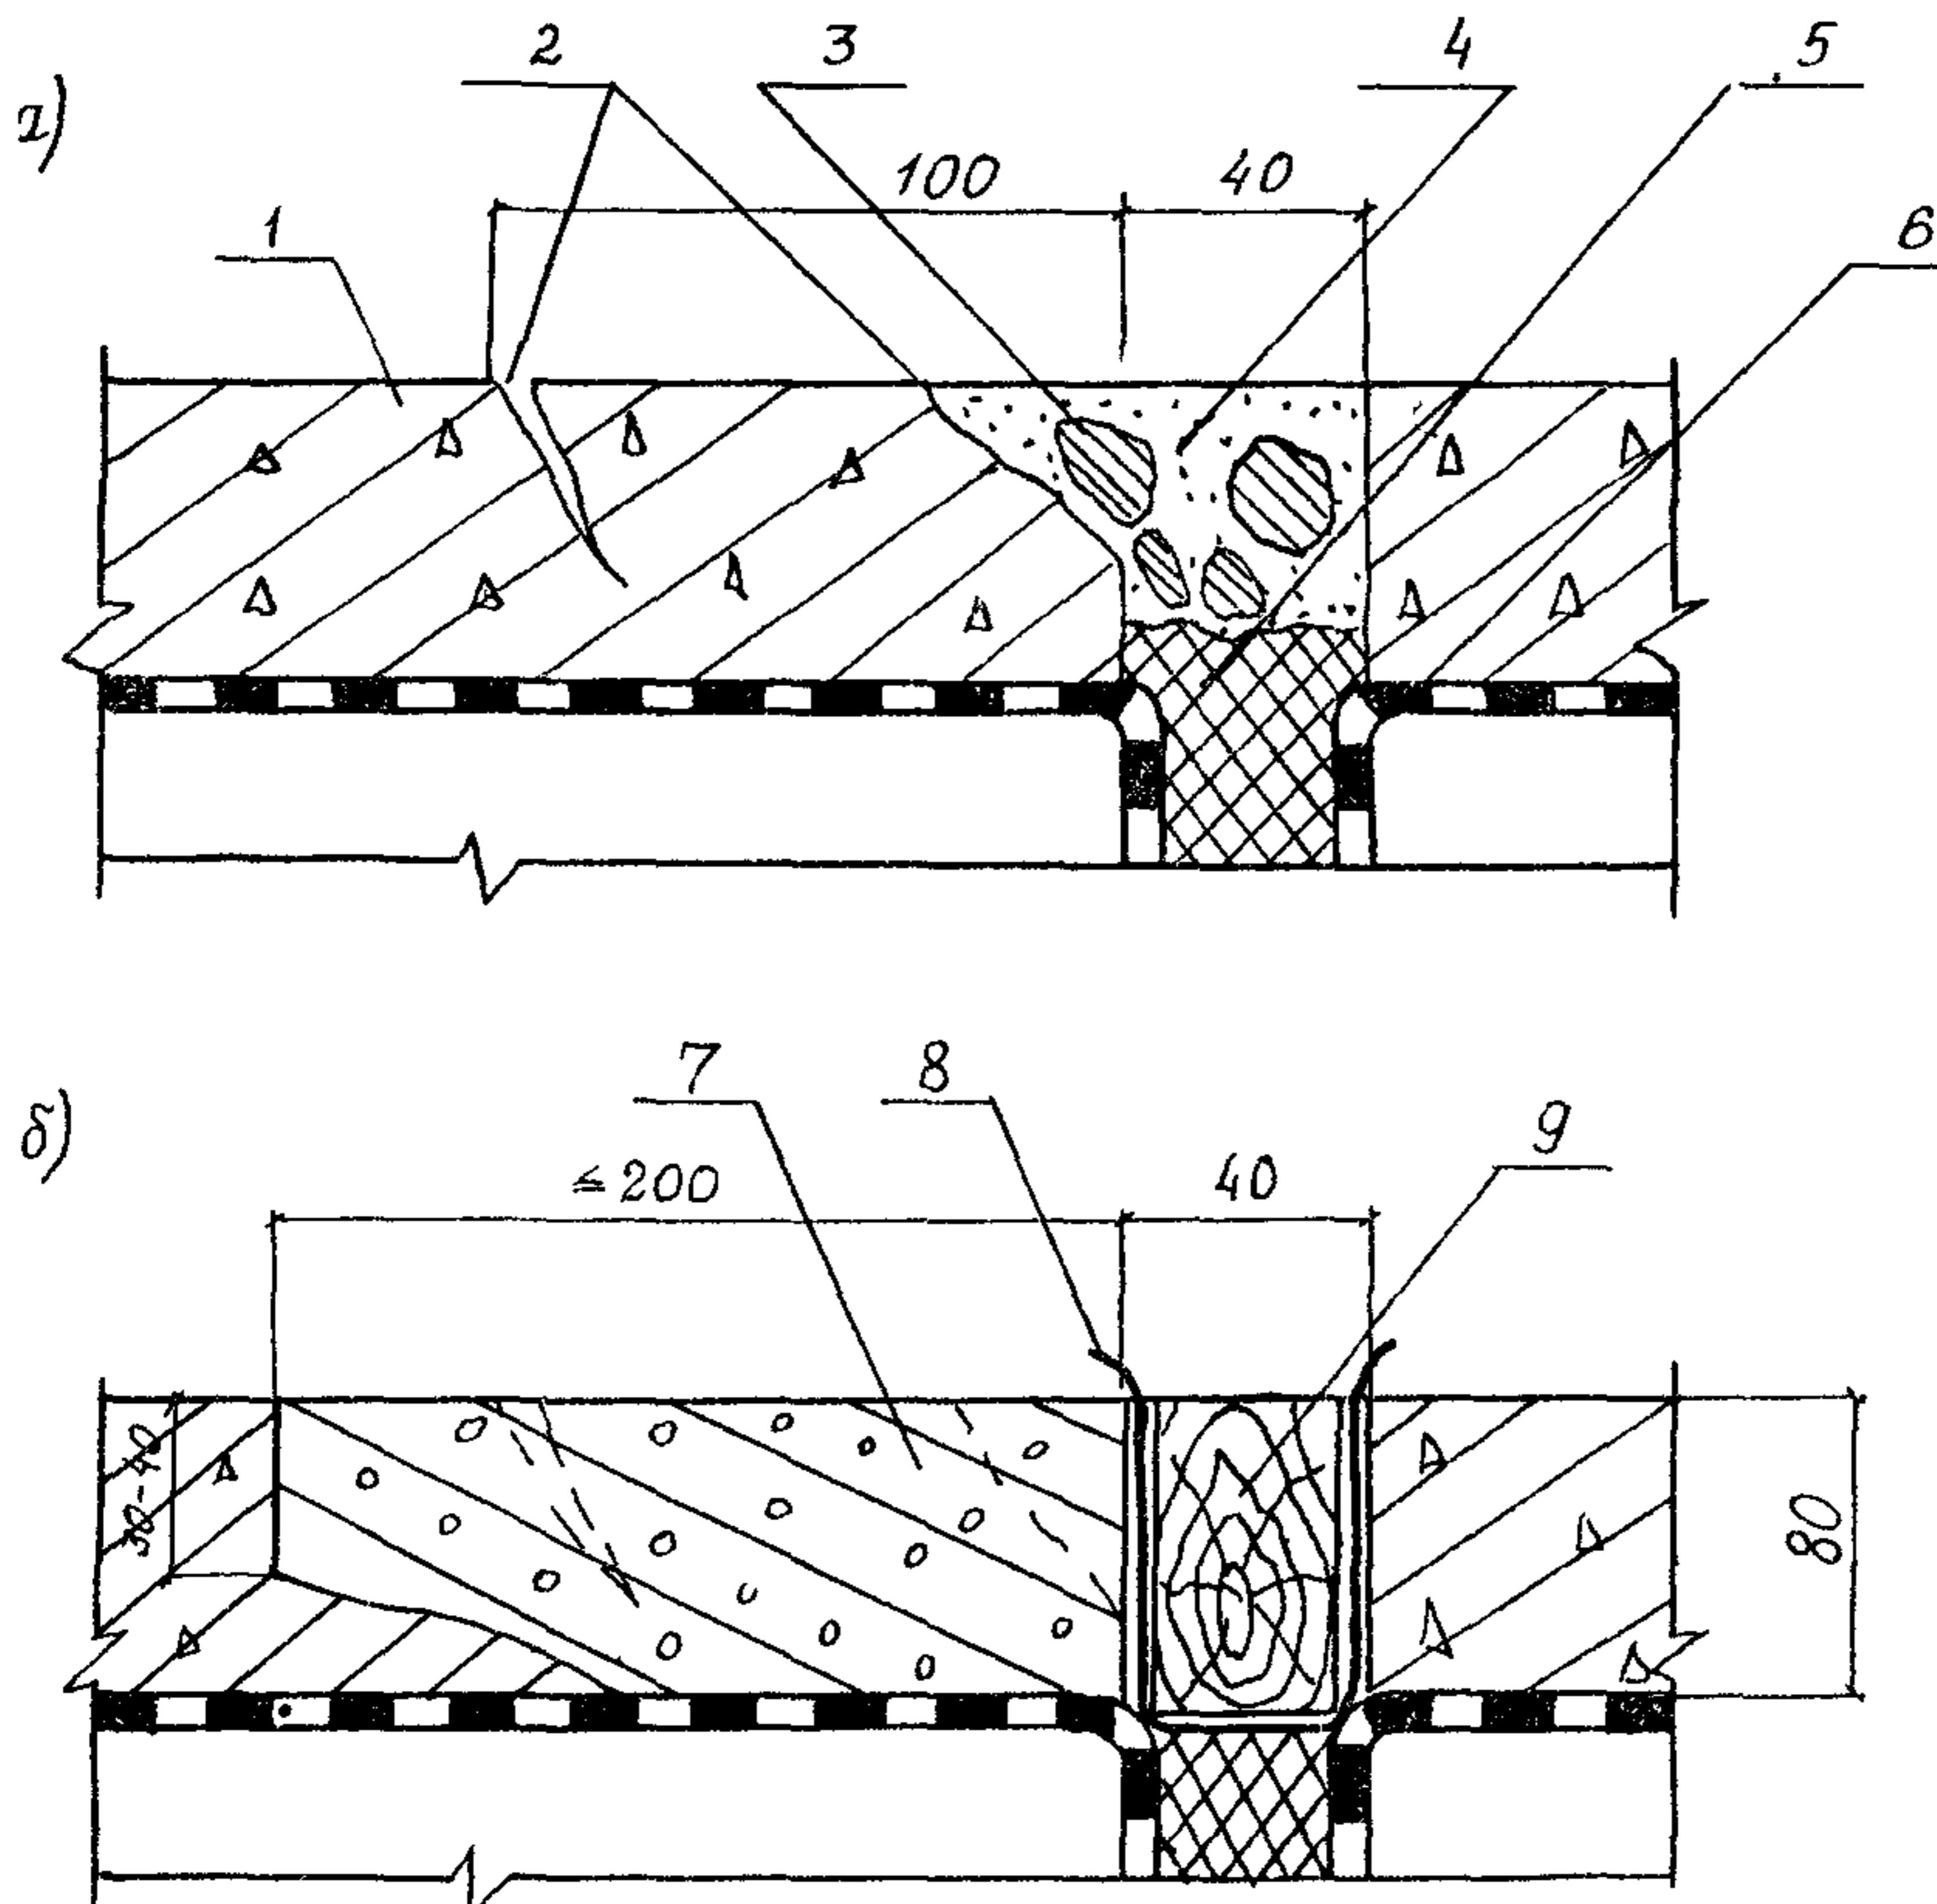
Схема ремонта скола кромки бетонного покрытия у шва:
